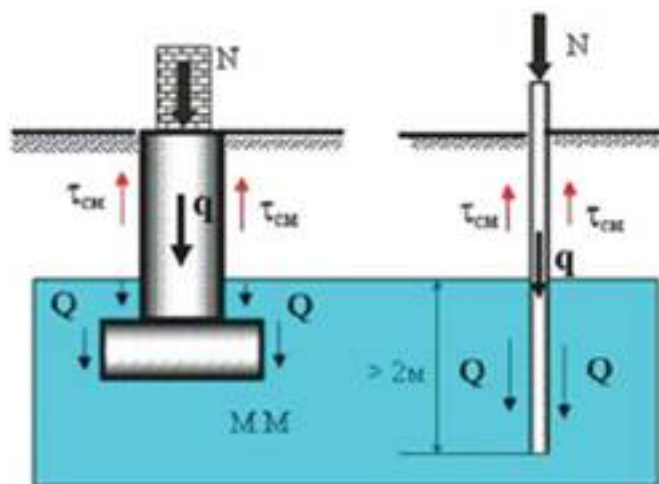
Расчетная схема устойчивости отдельно стоящих и свайных фундаментов в вечномёрзлом слое грунта
